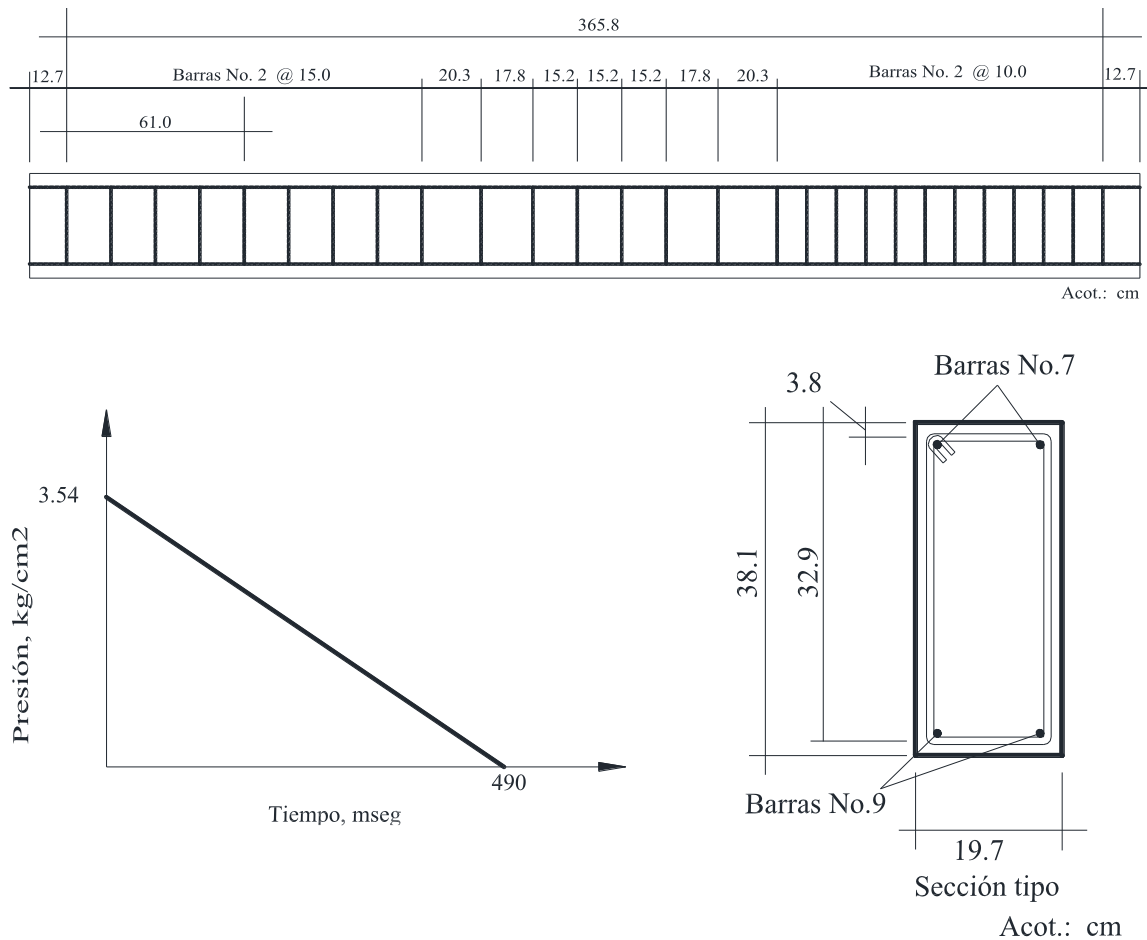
Detalle de armado y carga aplicada sobre la viga de diseño WD4-1.
